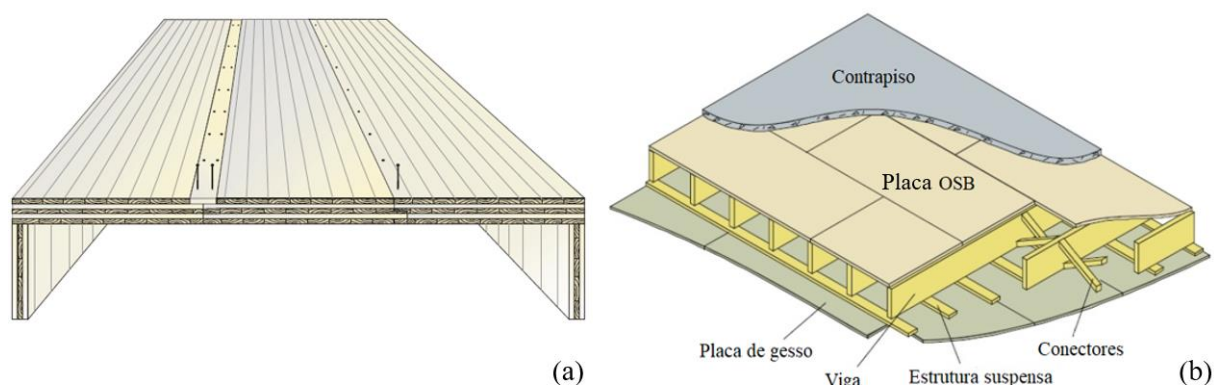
Lajes de piso em madeira. a) Seção transversal de uma laje em CLT puro; b) Transparência de uma laje em *wood-frame*. Adaptado de Karacabeily e Douglas (2013)
